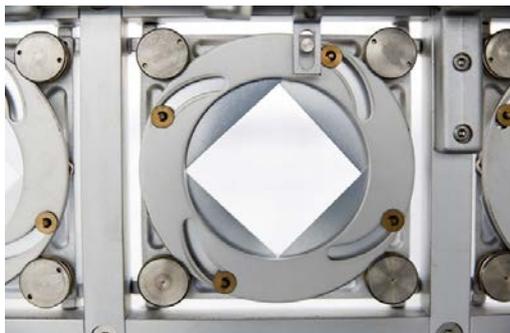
Detailansicht eines Fassadenelements des Institut du Monde Arabe
